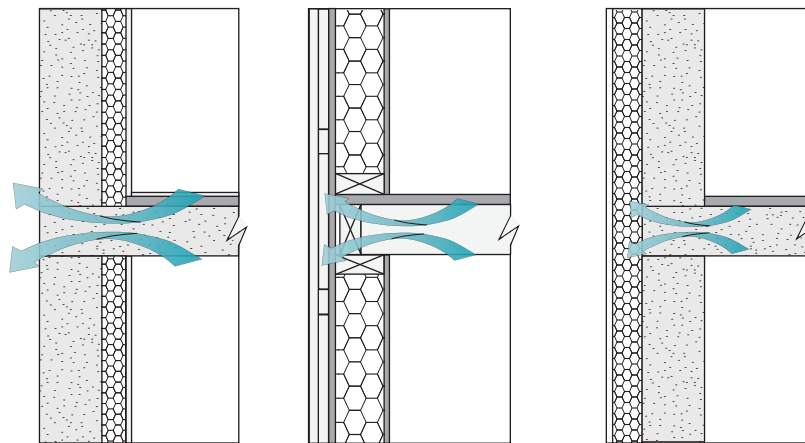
Comportamiento de los puentes térmicos en encuentros de piso y muro según la posición del aislante: Aislación interior: puente térmico significativo. Muro panel de madera: puente térmico débil. Aislación térmica exterior: puente térmico despreciable (elaborado por autores).
